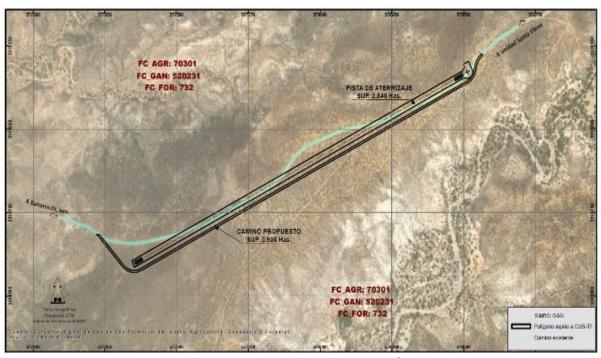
Proyecto de Pista de aterrizaje mina Santa Elena con camino existente y camino propuesto.
